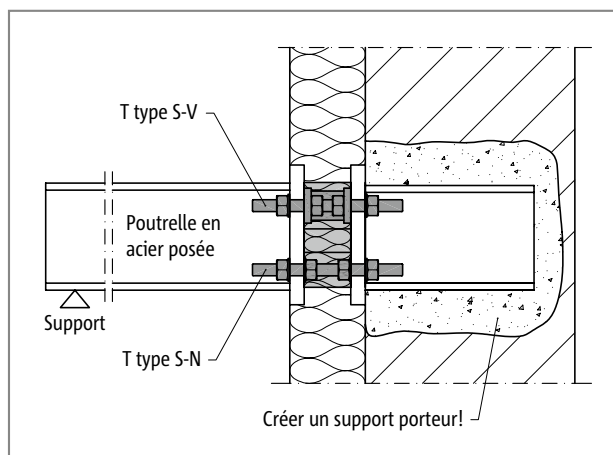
Schöck Isokorb® T type S-N et T type S-V : construction en acier supportée ultérieurement; pour d'autres exemples de rénovation, voir p. 96
